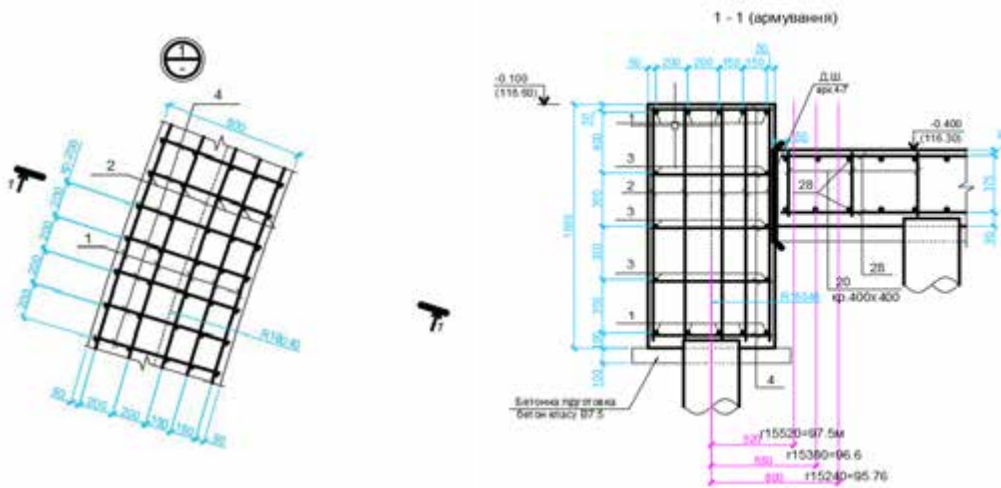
Приклад схеми вузлів армування ростверку плити фундаменту силосу
